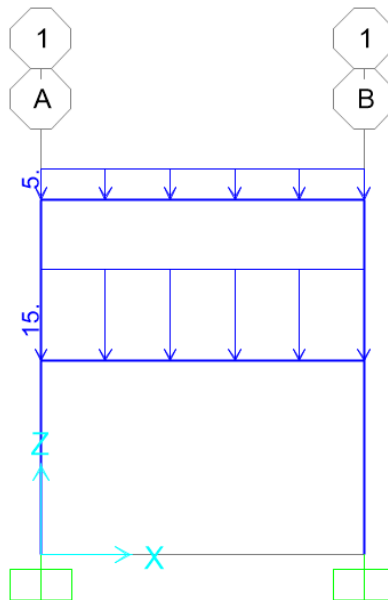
Vista en SAP2000 del Pórtico 1. Plano X-Z
